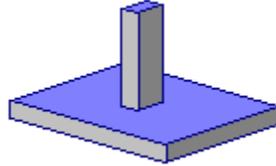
Zapata Aislada, Concreto, Cuadrada, Sección Constante, Interna
